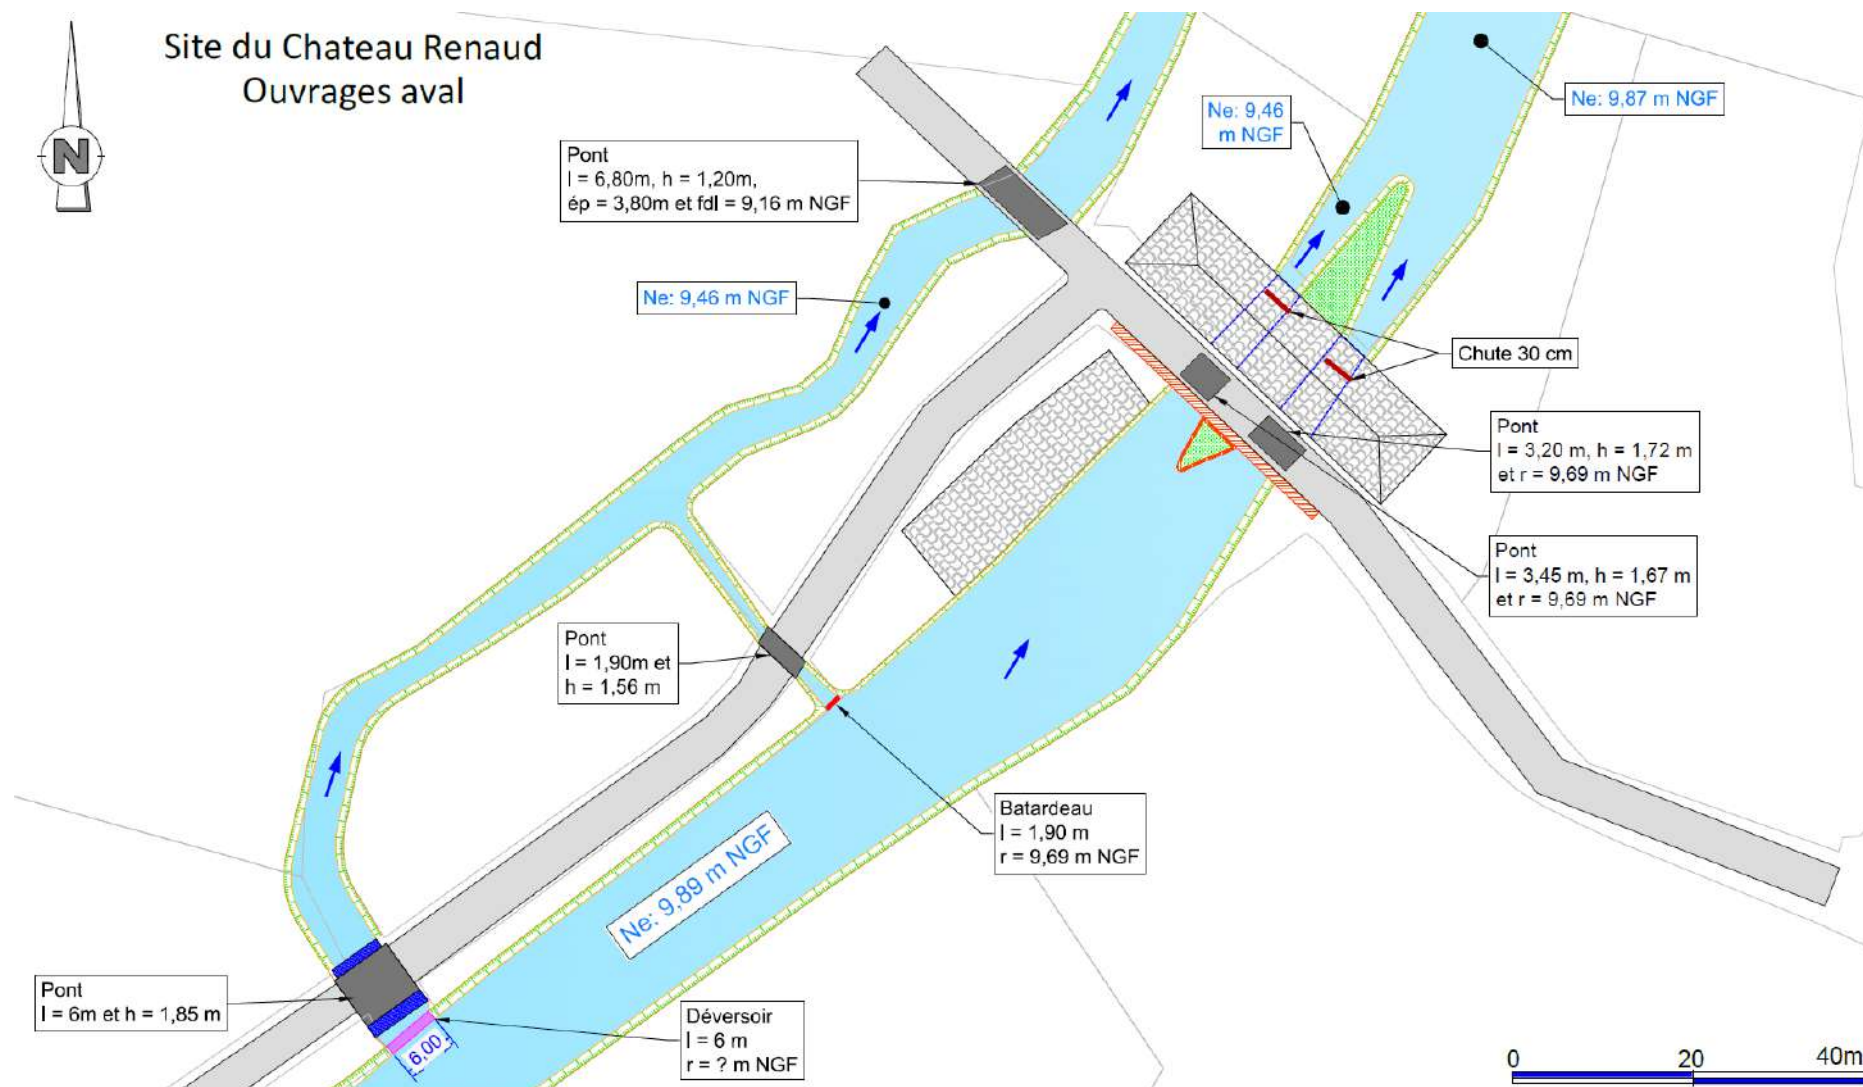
Vue en plan des ouvrages au droit du site de Château Renaudt
